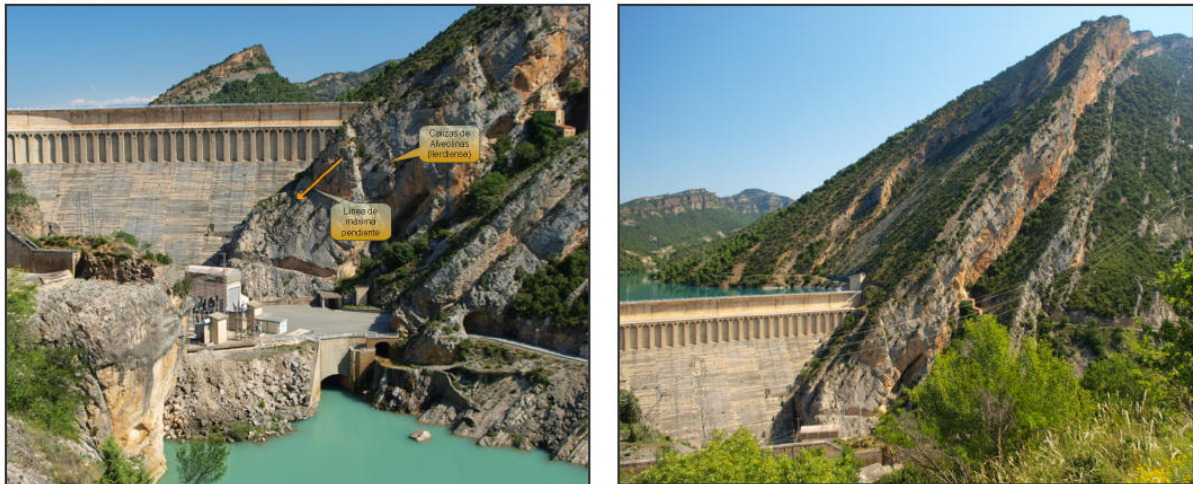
Detalles del apoyo del estribo izquierdo de la Presa de Mediano
